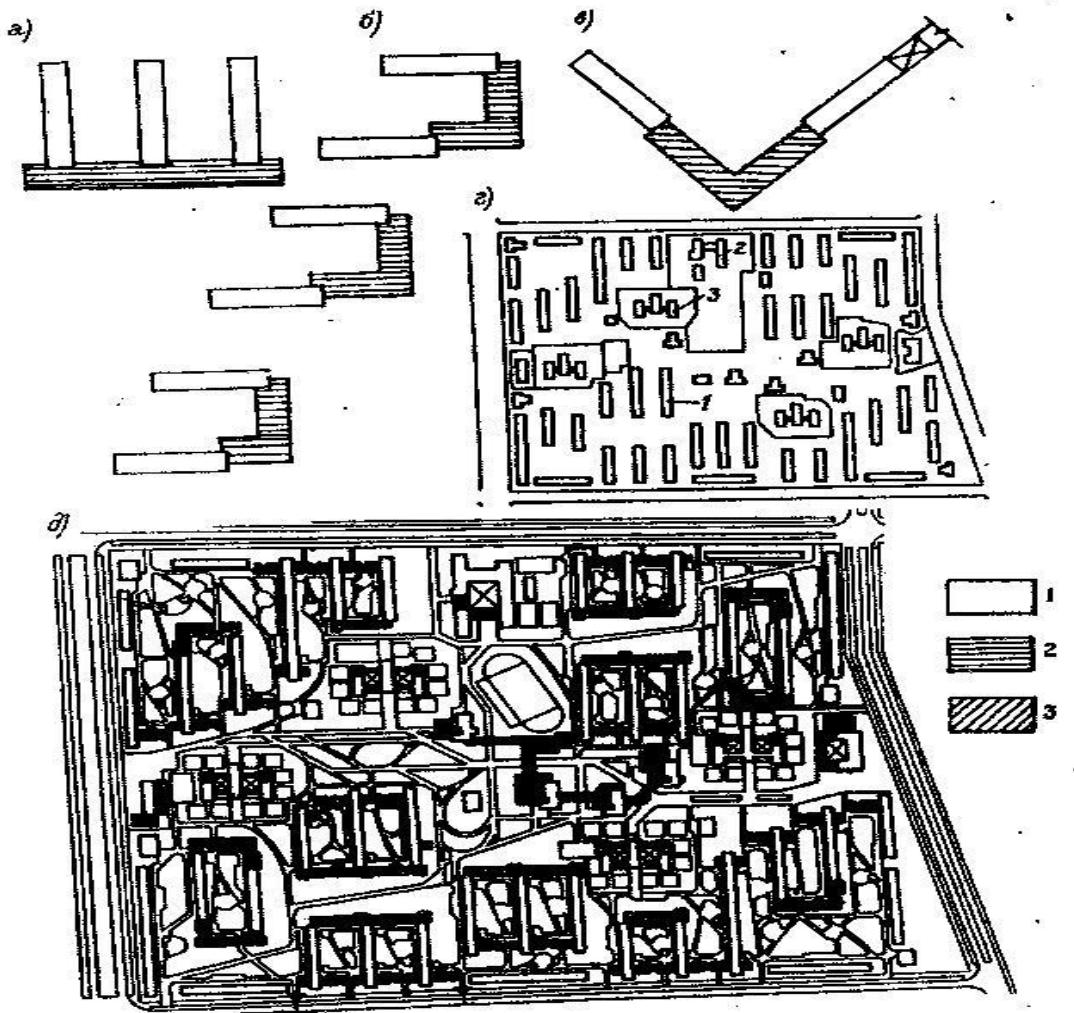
Схемы и пример уплотнения открытой пятиэтажной застройки
